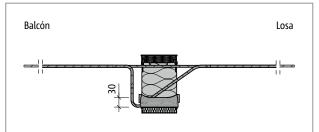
Schöck Isokorb® XT tipo K-M5, K-M6: Sección del producto
